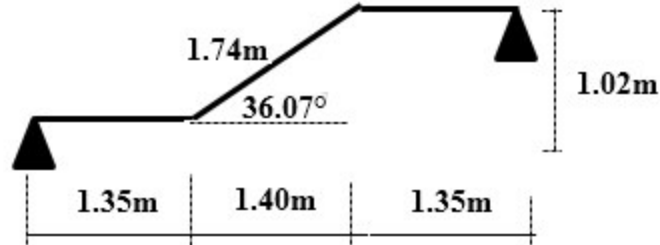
Schéma statique de la poutre brisée de l'escalier.
